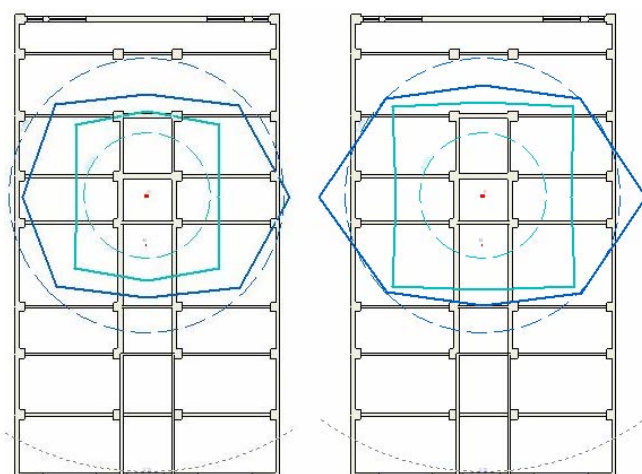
Dominios de resistencia para distribución constante y lineal de cargas (planta baja).
